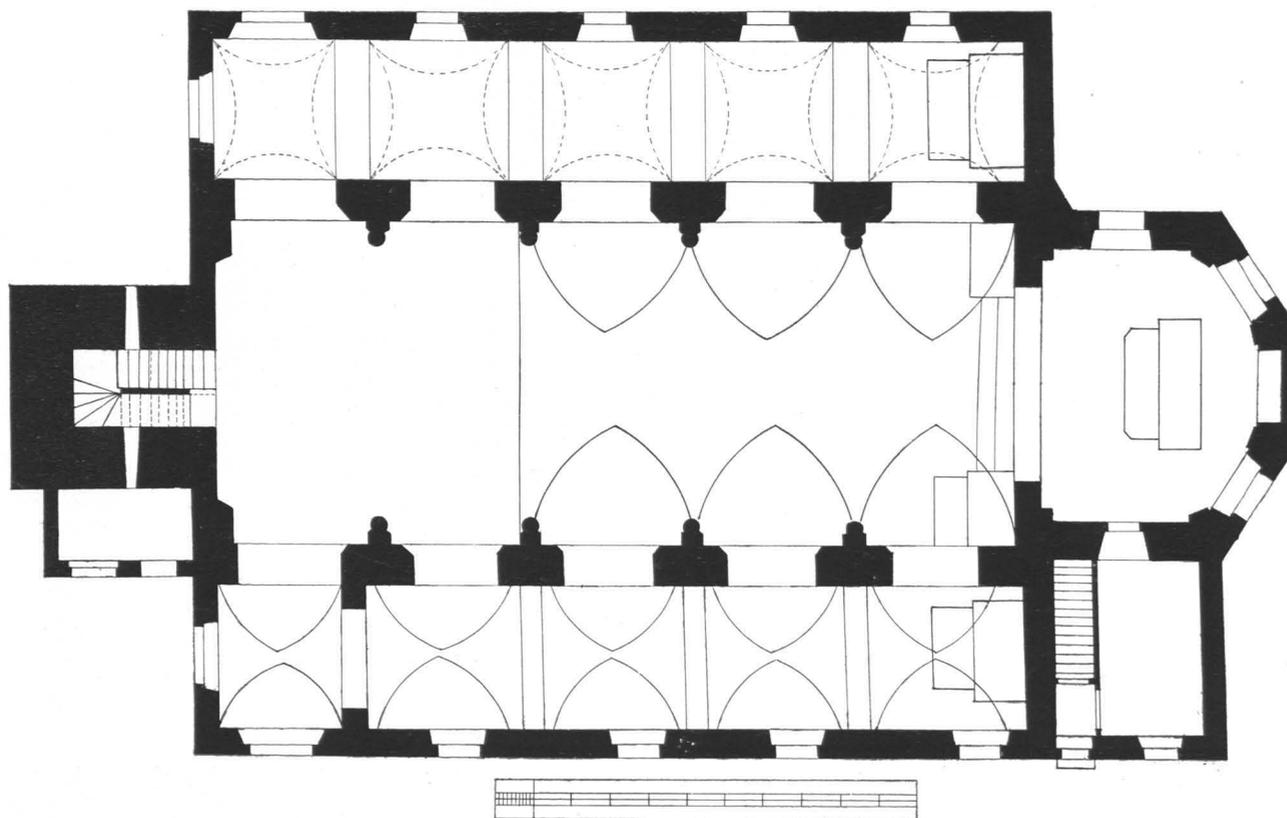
Obertrum, Pfarrkirche, Grundriß 1:200 (S. 337)
